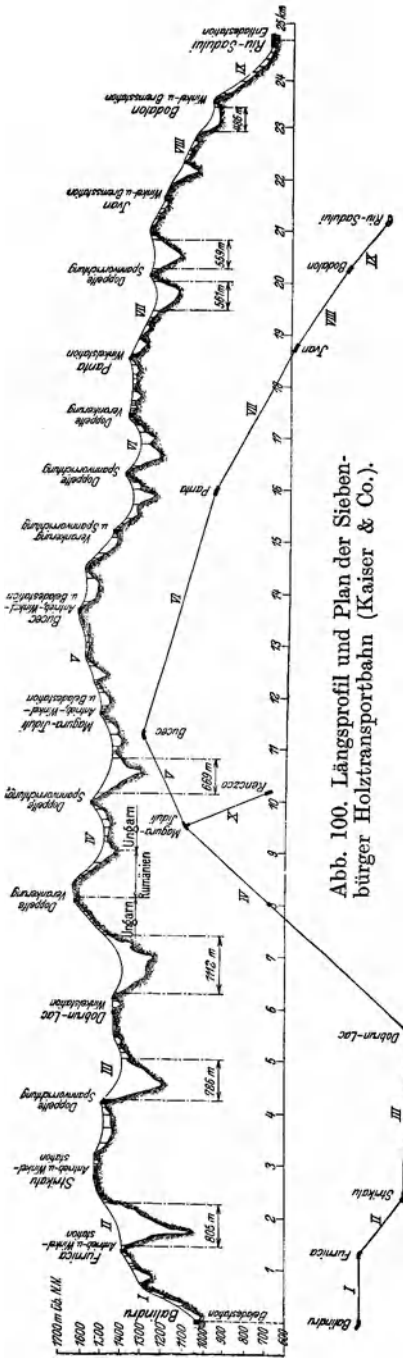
Längsprofil und Plan der Siebenbürger Holztransportbahn (Kaiser & Co.).
